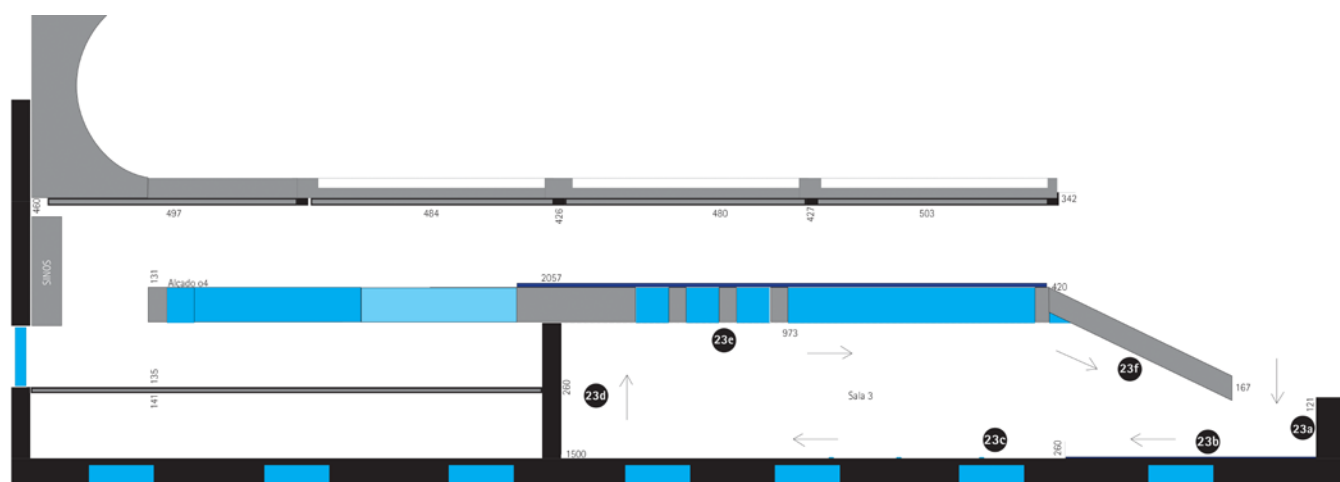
Planta da sala de exposição – Povoado Fortificado de Vila Nova de São Pedro.
